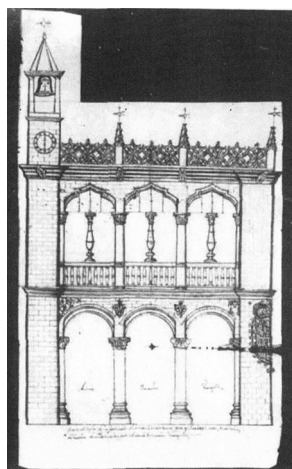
Varagaña. Fachada Ayuntamiento. Alzado de estado actual antes de su derribo.
